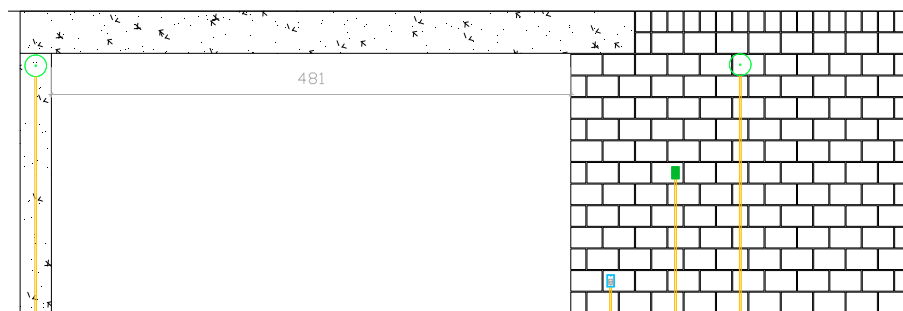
Detalhe 2, interface da viga com a alvenaria.
